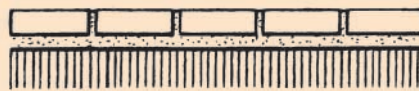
Disposición tizón en plano con ancho de junta (8-10mm). Idónea para zonas poco sobrecargadas, por ejemplo, jardines o para colocación sobre lecho de mortero.
